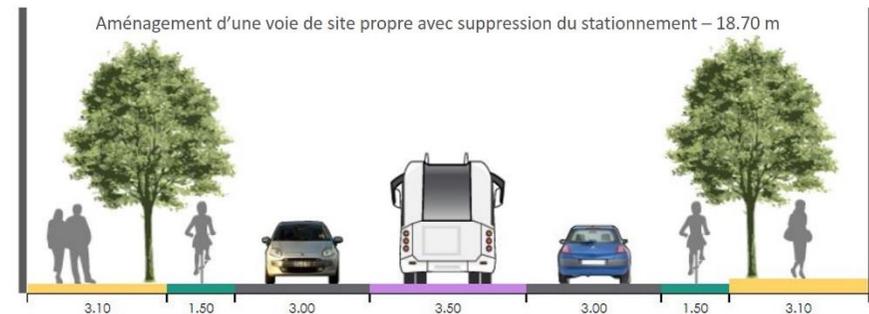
Variante – Aménagement d'une voie de site propre avec suppression du stationnement
